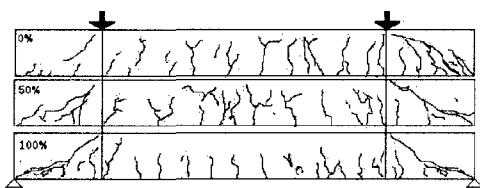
ひび割れ発生状況 ($a/d=2$)
